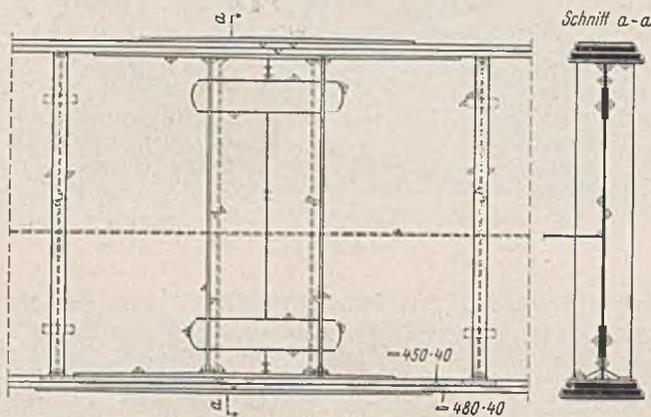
Eisenbahnkreuzungsbauwerk bei Mainz-Süd. Hauptträger.
